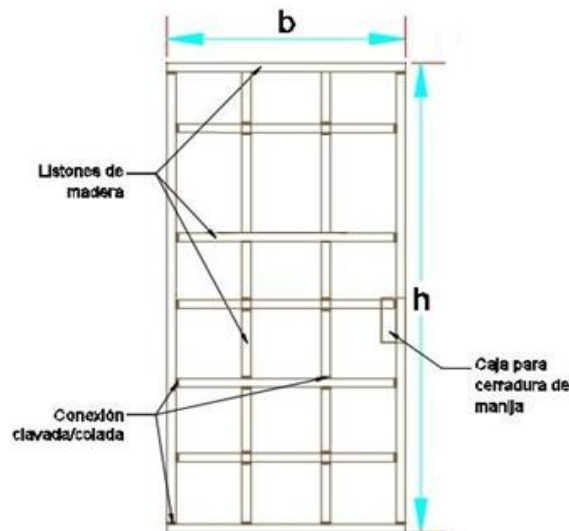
Armazón de listones de madera para puerta Contraplacada con paneles de triplay lupuna.
